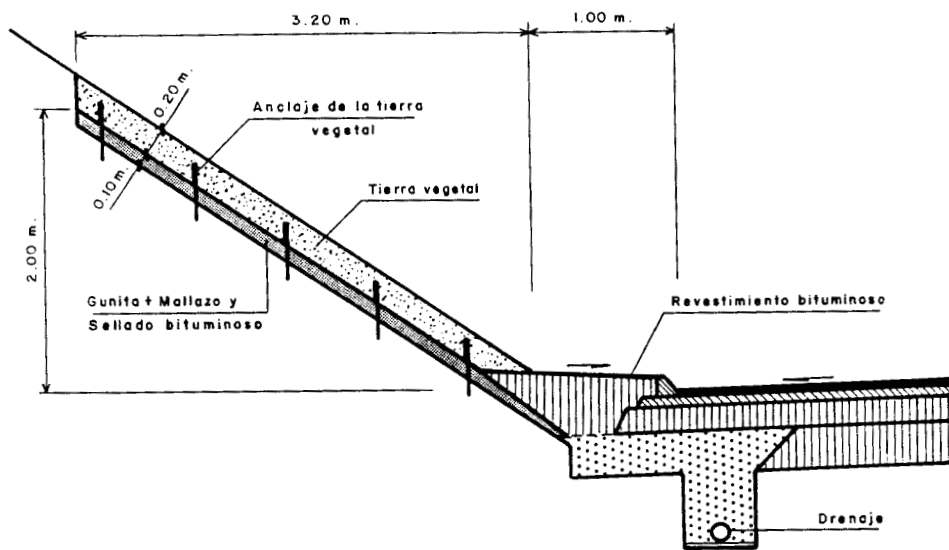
Seccion en desmonte con barrera impermeable.
